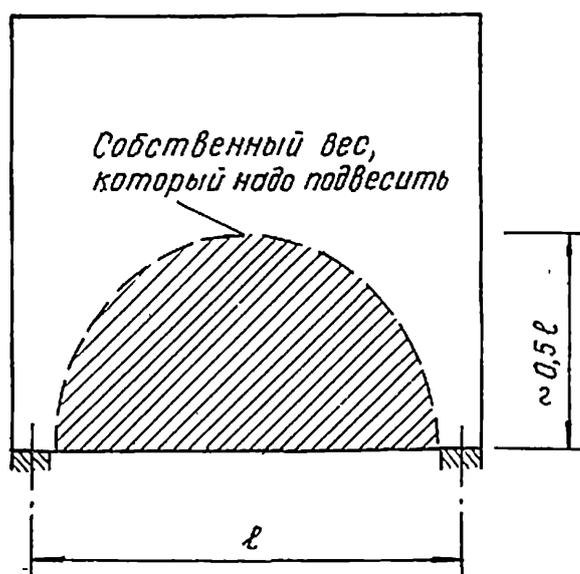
II,б. Зона собственного веса, требующего подвешивания
